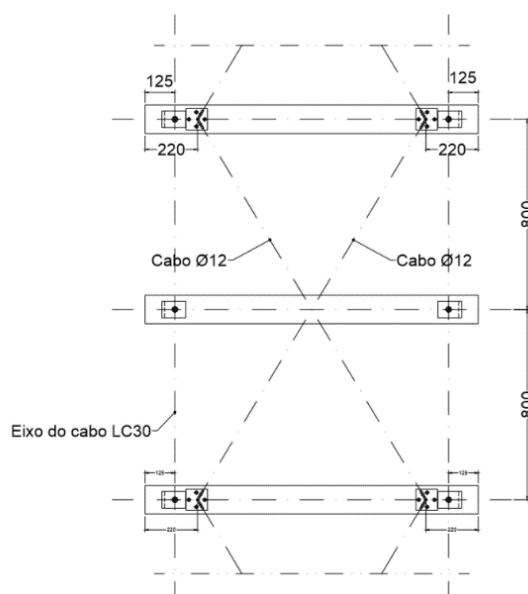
Pormenor em planta dos cabos de contraventamento dispostos em cruz com medidas em mm (FASE Estudos e Projetos, 2014).
